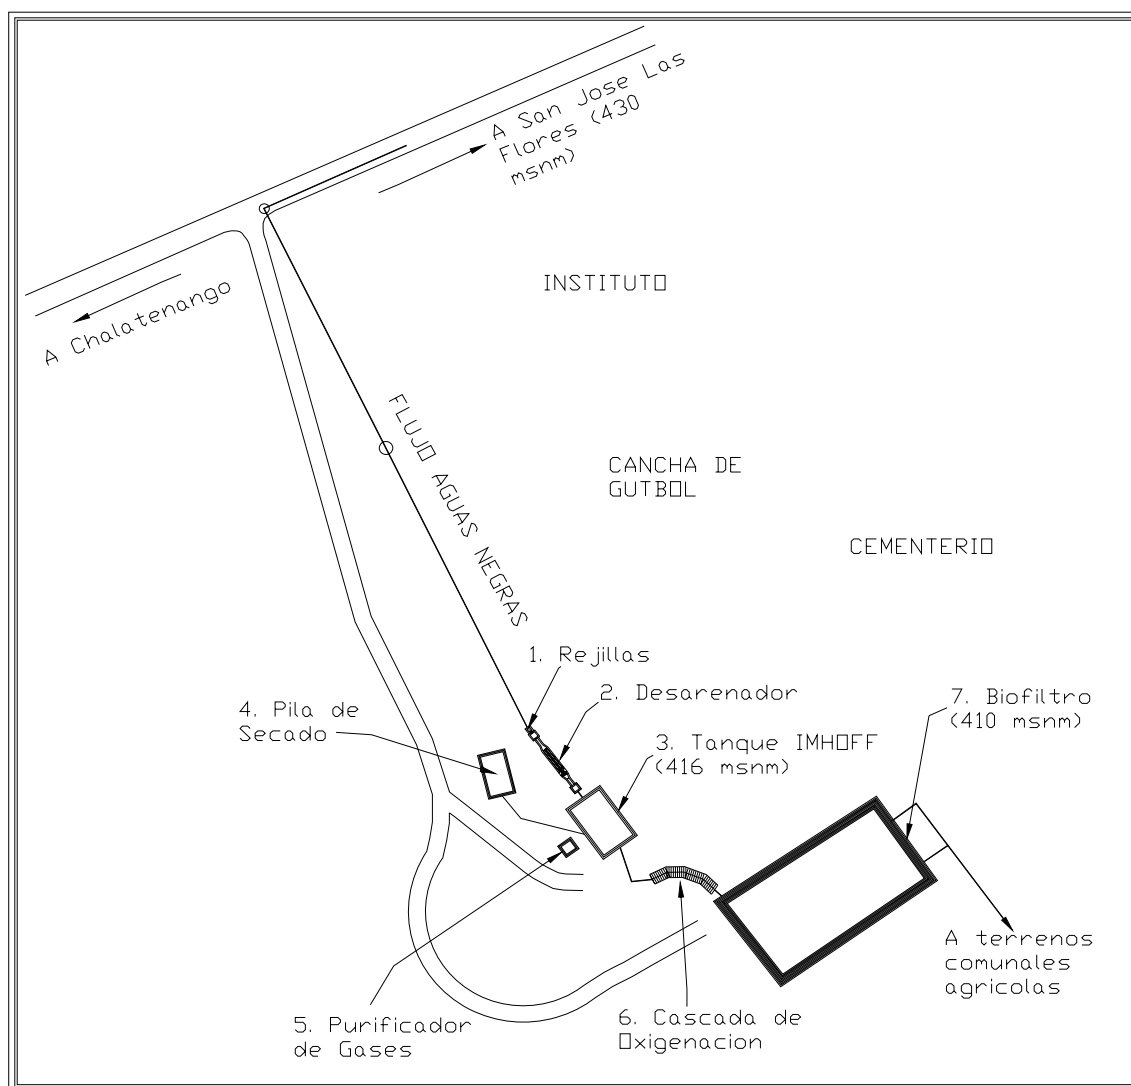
Esquema general de planta de tratamiento de San José Las Flores, Chalatenango
